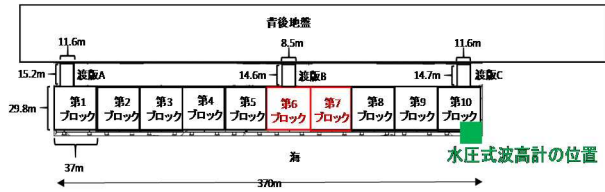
小名浜港の観測対象栈橋の平面図（再掲）
